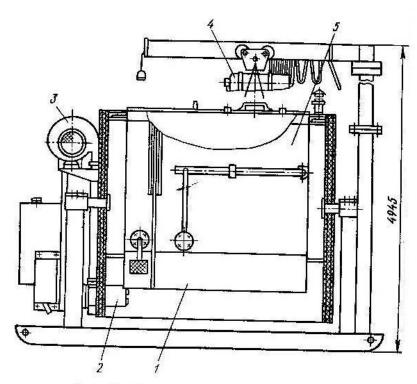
Битумоварочная установка УБВ-1: t — кориус. 2 — форсунка, 3 — вентилятор, 4 — таль, 5 — котел
